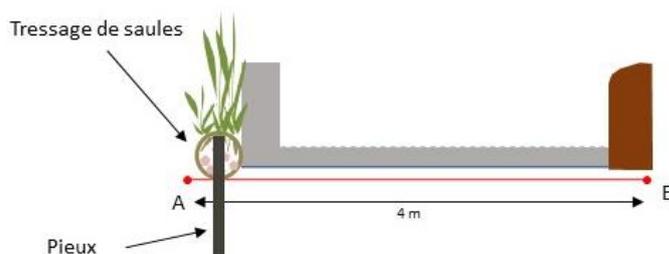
Schéma de l'ouvrage amont de répartition en hautes eaux - coupe en travers
